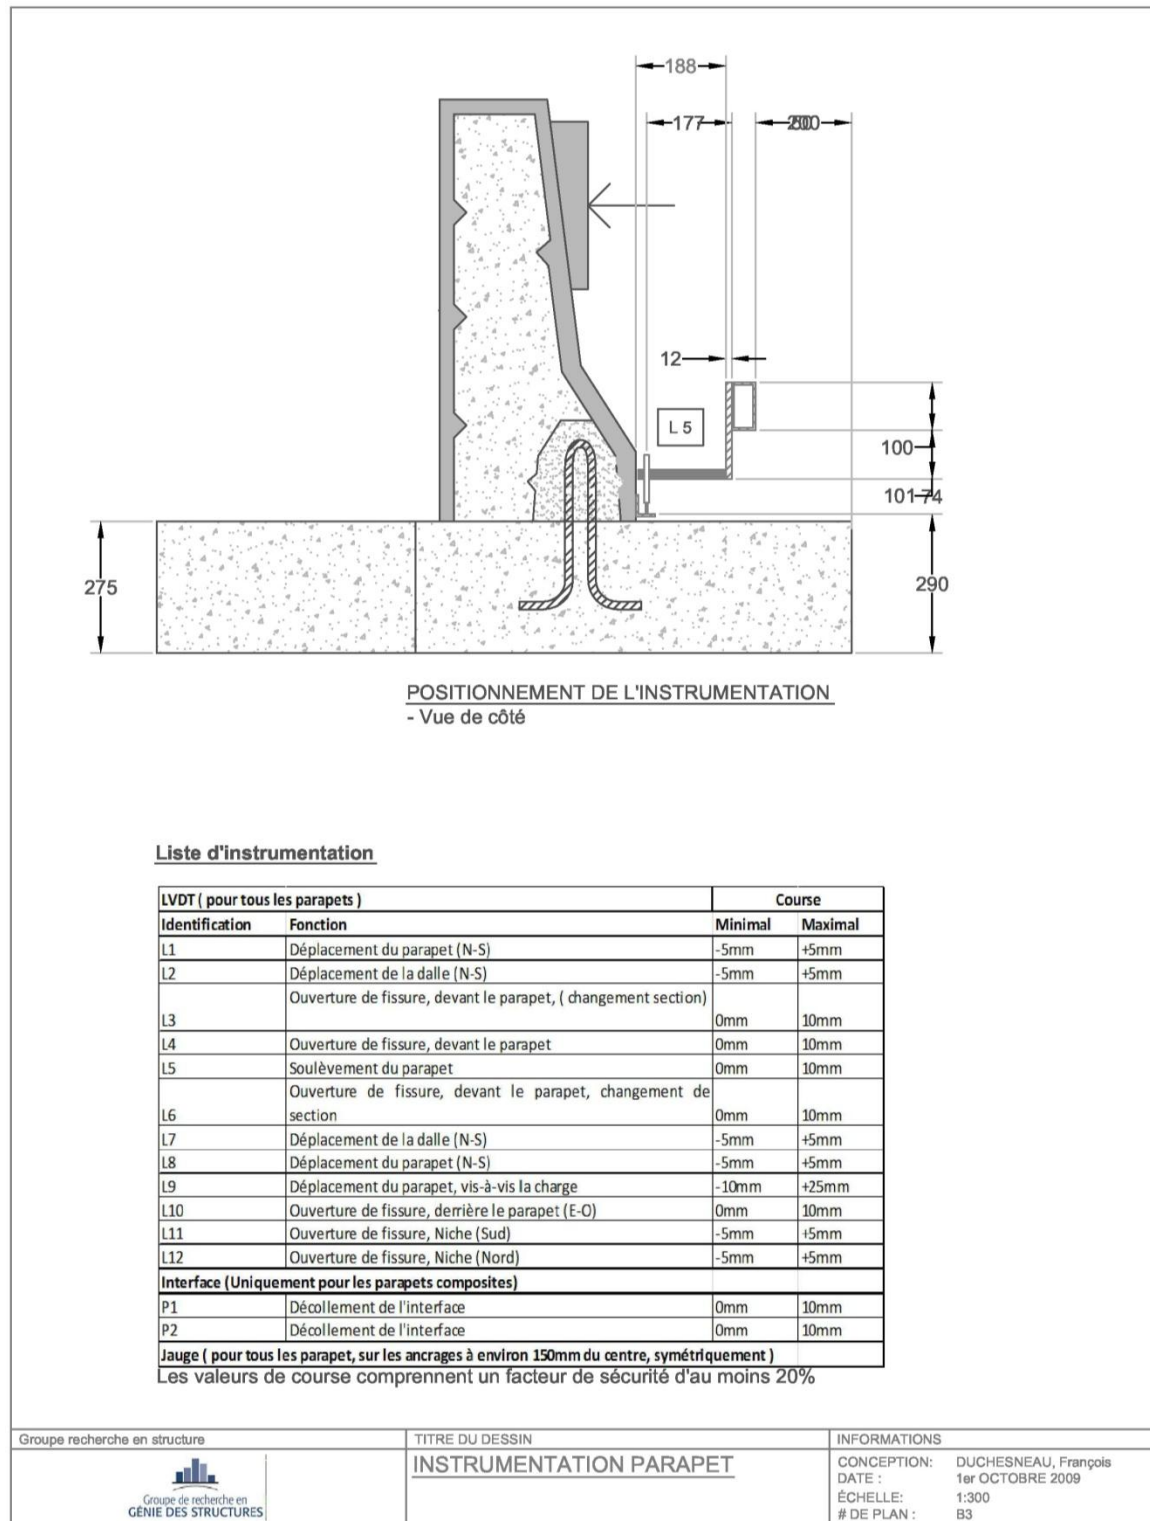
Plan d'instrumentation des parapets vue de profil et liste de l'instrumentation
